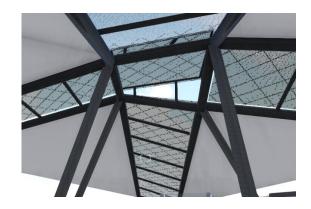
Estructura metálica del techo del terminal Fuente: Autor
